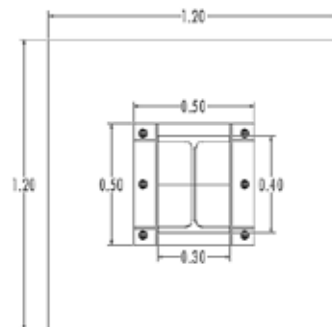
Detalle de fundación en planta. Fuente: Sosa (2020)
